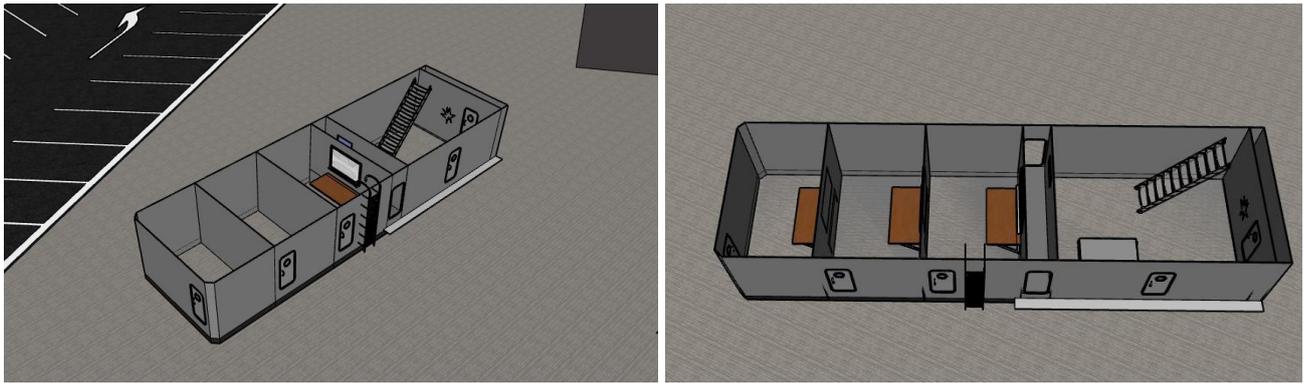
Planta baja del adiestrador de control de averías modelado en SketchUp
